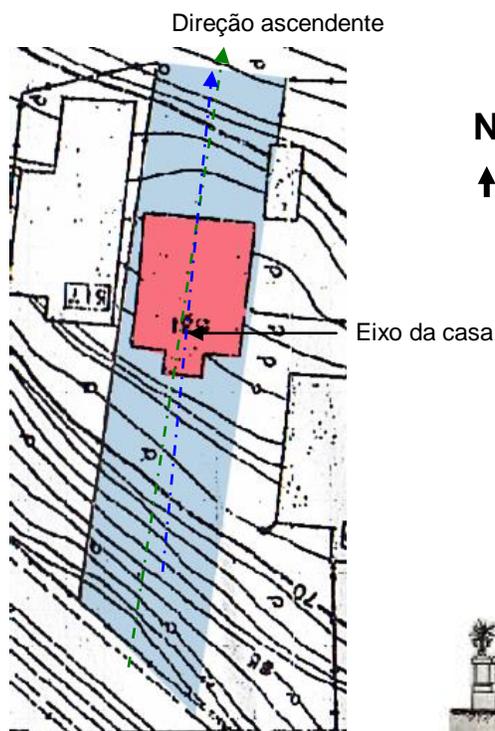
Implantação da casa no sentido longitudinal do terreno.
